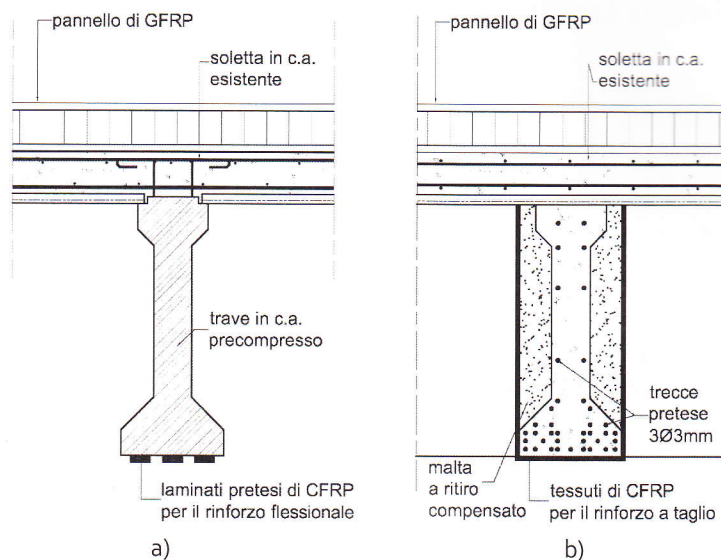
Rinforzo dell'impalcato: a) sezione corrente; b) sezione all'appoggio.
